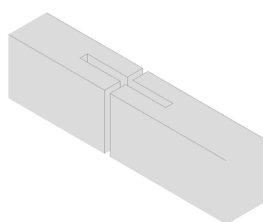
Imagen de la acanaladura que se practica a las piedras en su canto horizontal para su anclaje a la subestructura.
